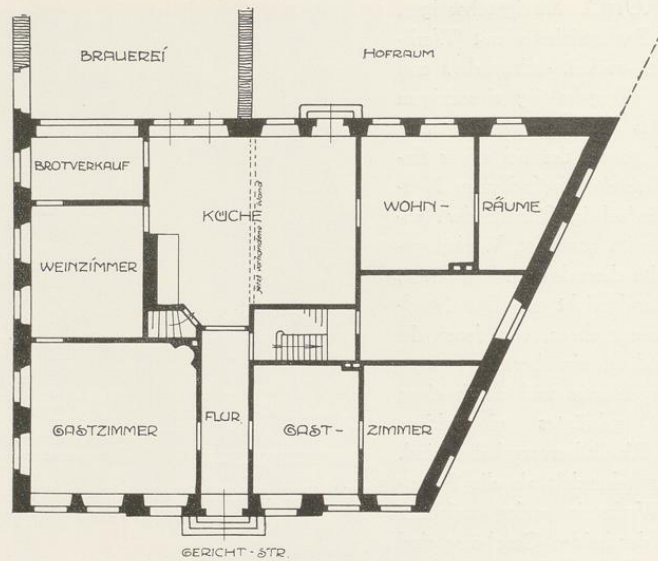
Rekonstruktion des Grundrisses des Hauses Gerichtsstraße 1
